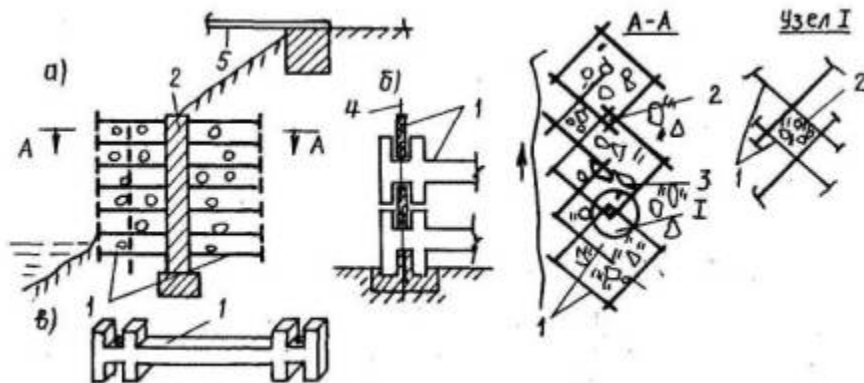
Укрепление устоев мостов армированием грунта откоса железобетонными элементами:
